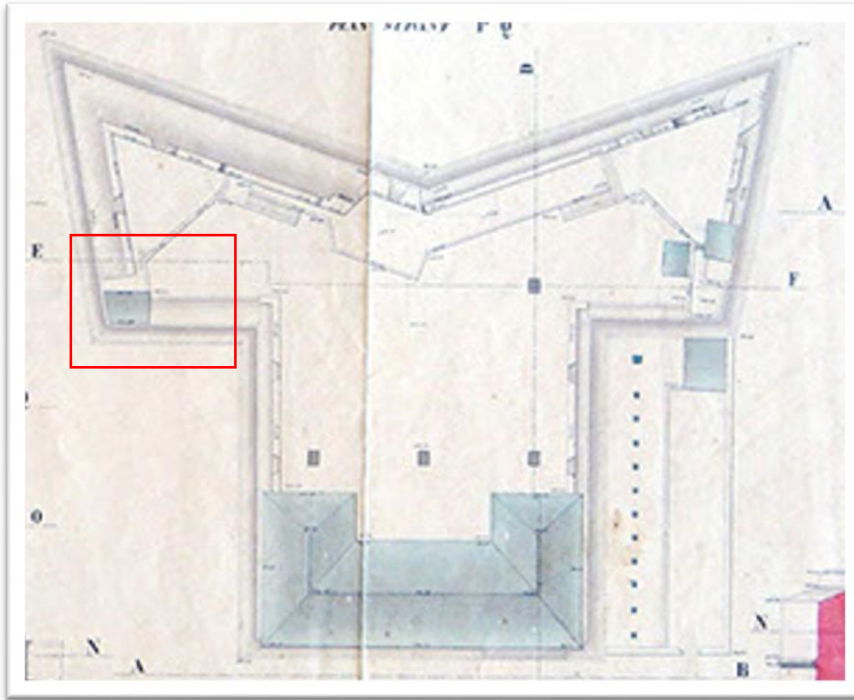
Plan de toiture établi par le génie militaire français, montrant les toitures
